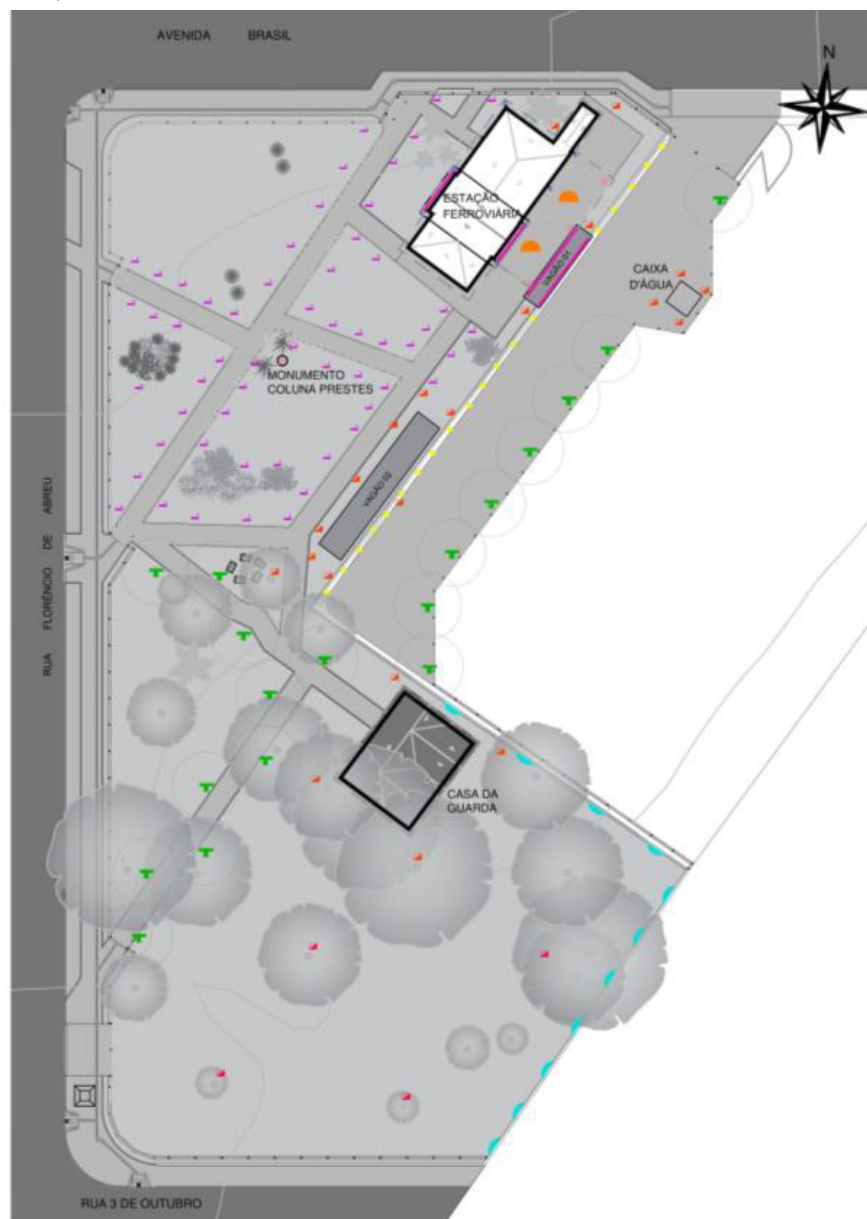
Planta baixa dos pontos de iluminação.
